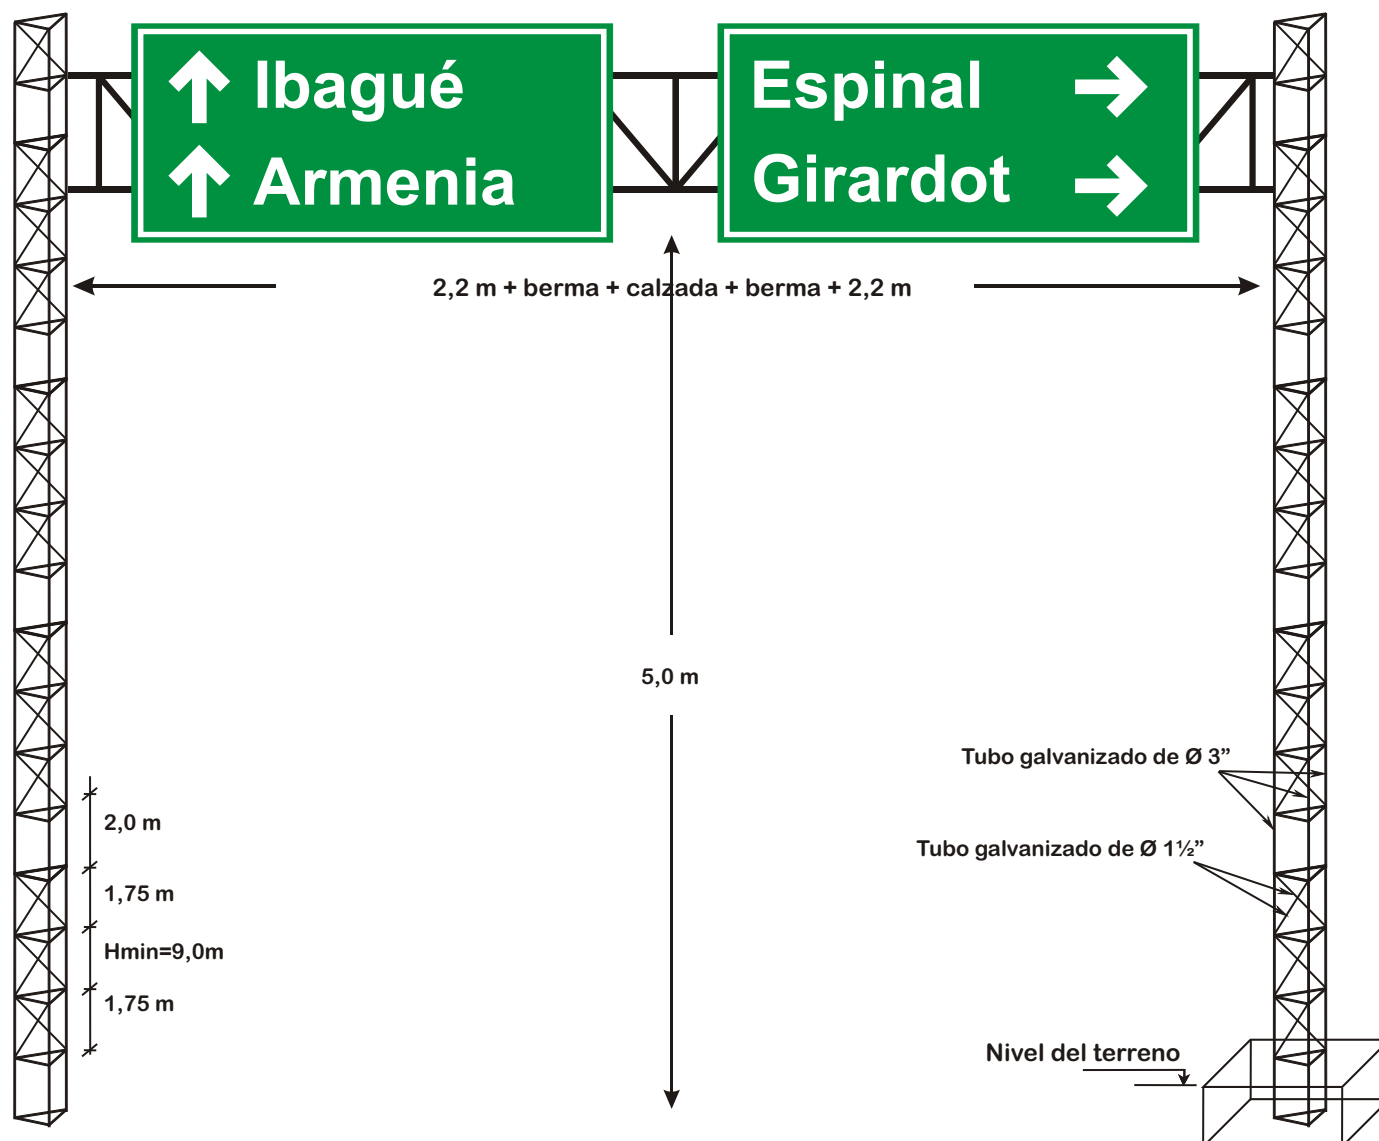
Señal elevada tipo doble bandera (Dimensiones en m)
